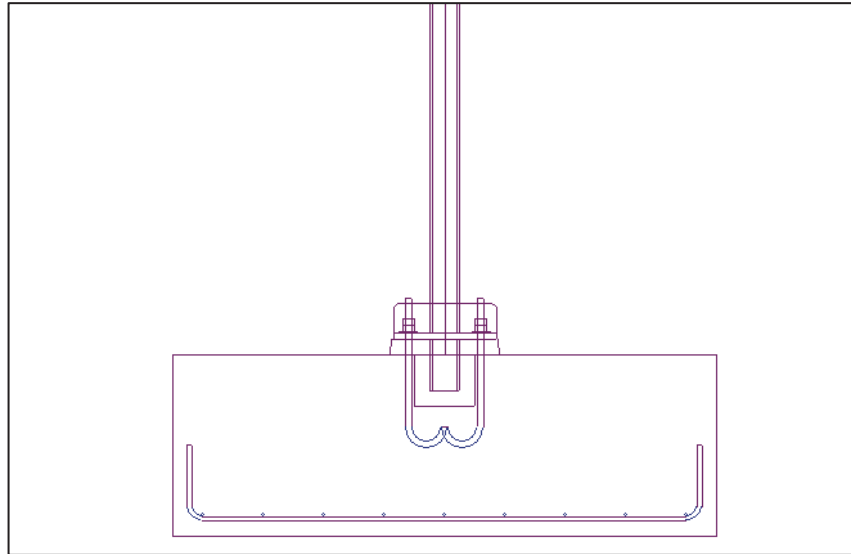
Detalle de las zapatas de los pórticos hastiales de los lazaretos.
